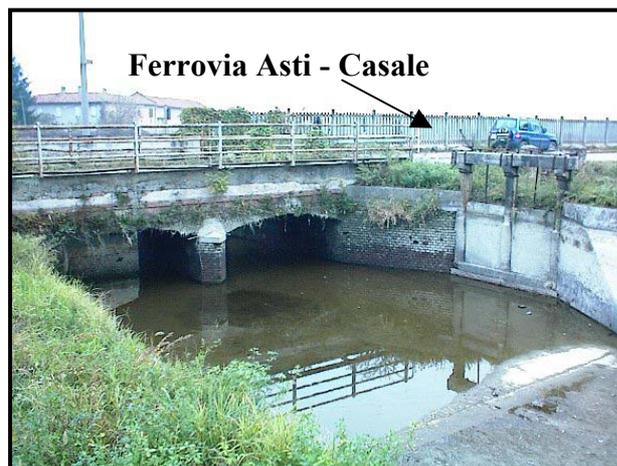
Vista dell'attraversamento del canale Lanza, lungo la strada vicinale e sifone lungo la ferrovia.
